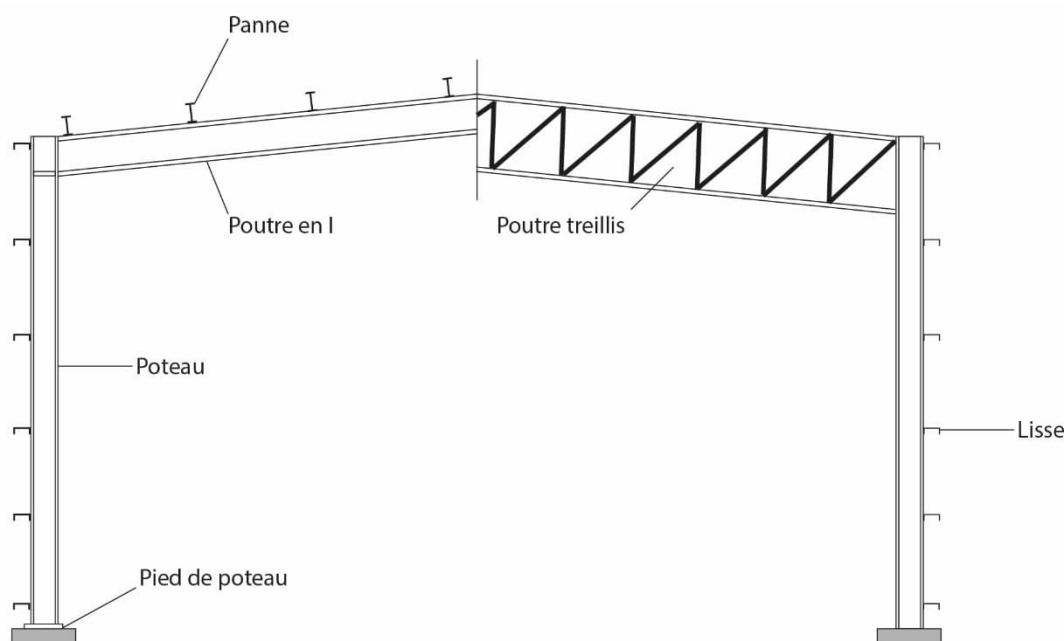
Éléments structuraux d'un bâtiment en acier typique à simple rez-de-chaussée
